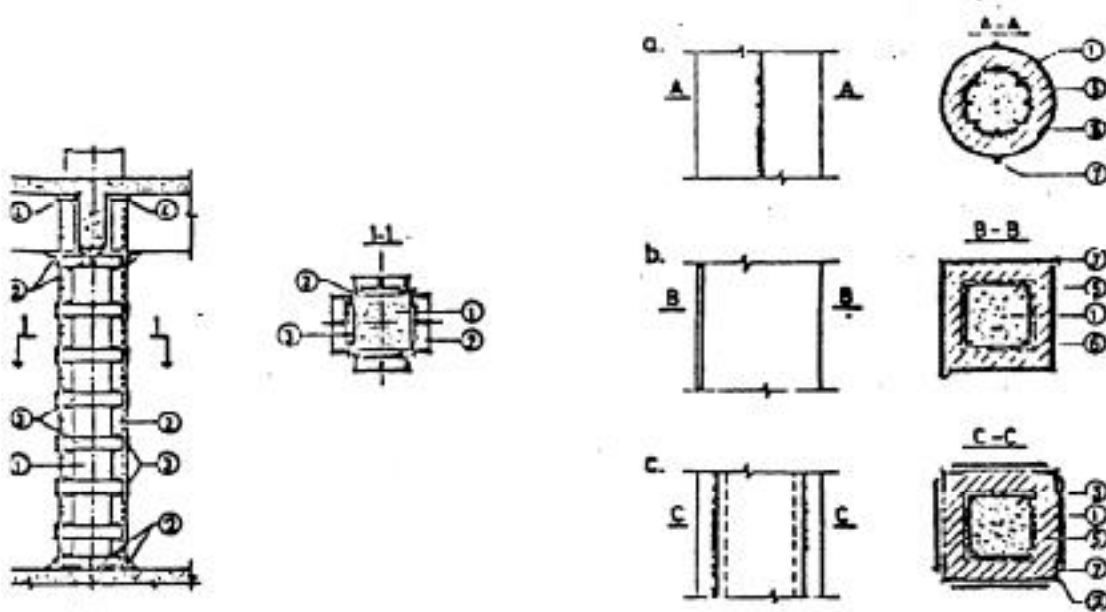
Encamisado parcial de columnas con concreto reforzado (ref. 1)
